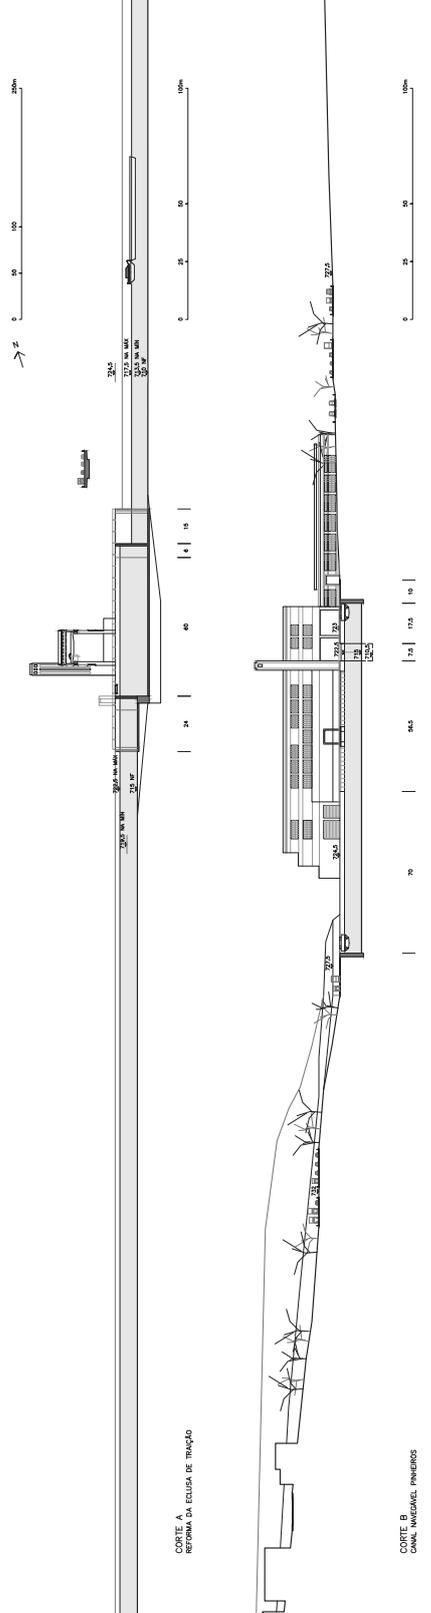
Planta - reforma da eclusa existente de Traição. Fonte: GMF
